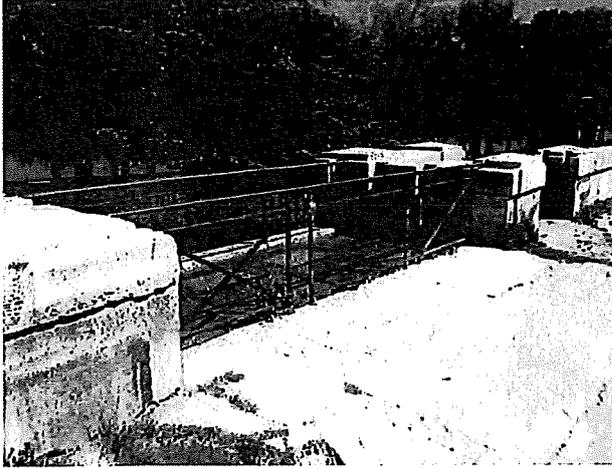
Emplacement du Batardeau B12 au-dessus de l'ancienne porte de St Pierre
